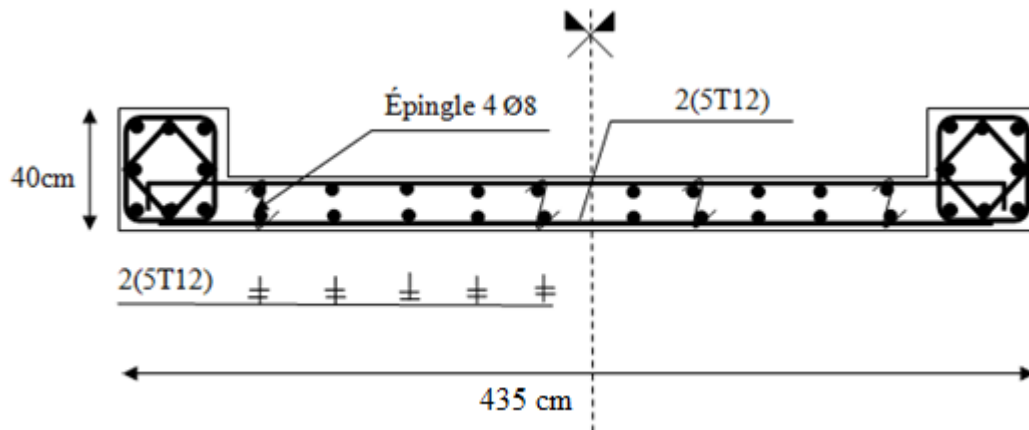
Schéma de ferrailage du mur voile (Type1).
